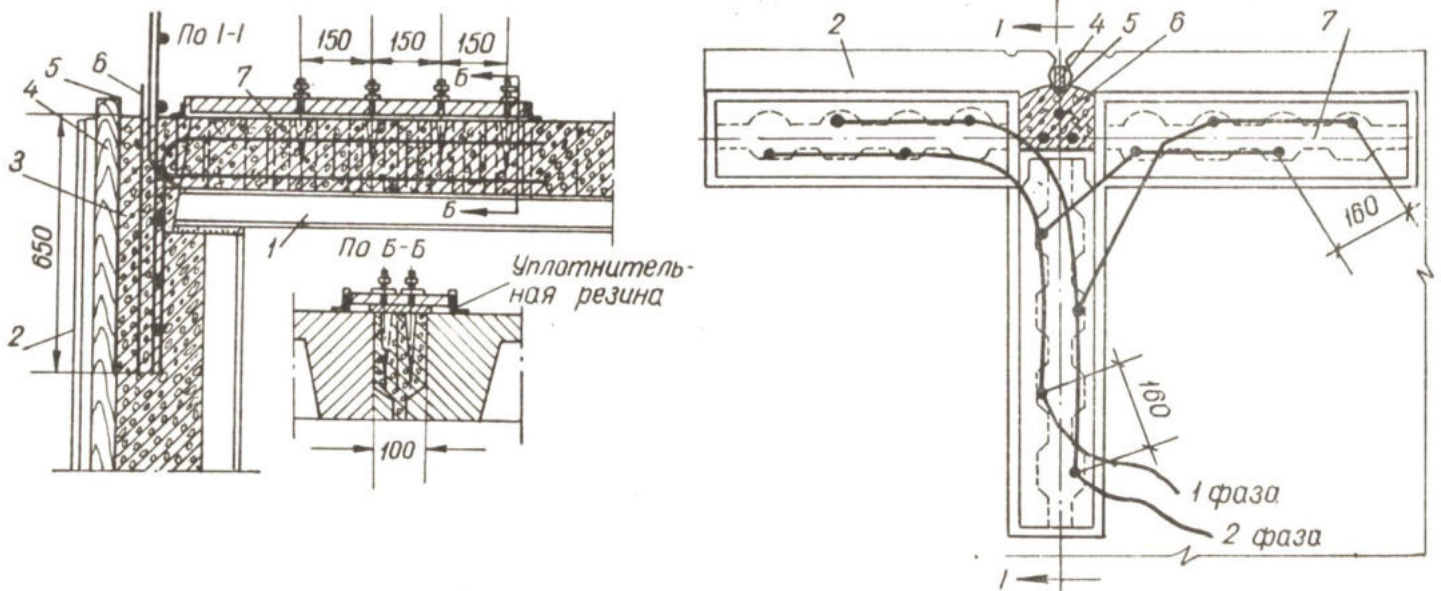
Схема прогрева бетона в стыках с помощью электродных панелей: 1—панели перекрытия; 2—наружная стенная панель; 3—бетон; 4—рейка; 5—электрод на рейке; 6—электрод в бетоне; 7—электродная панель.
